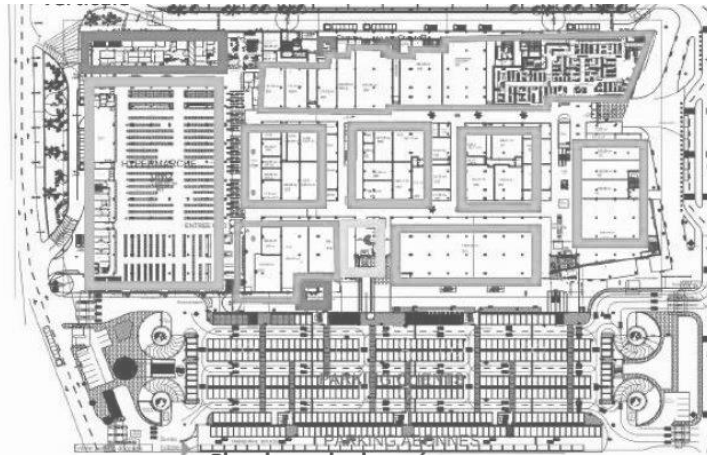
Plan de rez de chaussée centre commercial et loisir - Source : E-s Senia.
